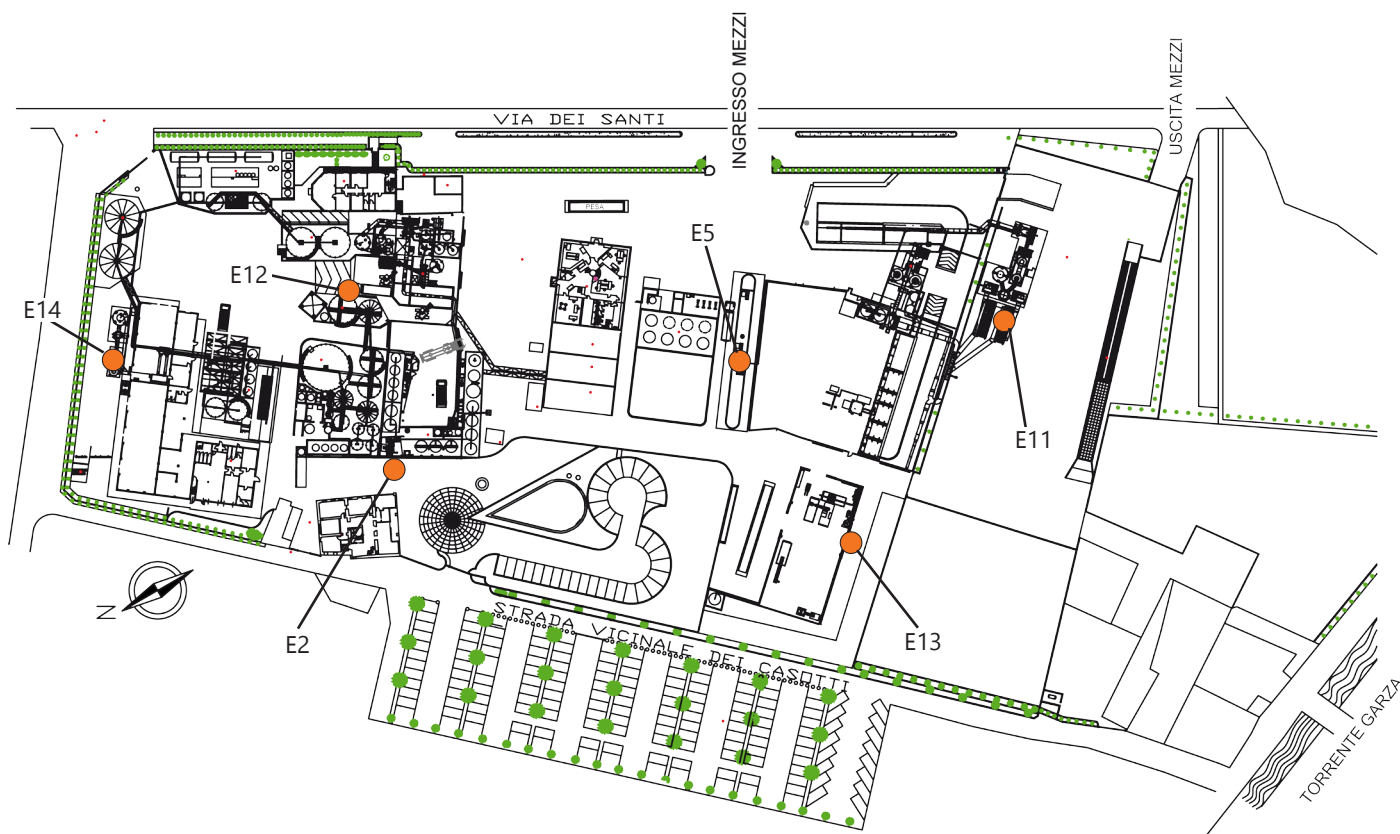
Planimetria dell'U.O. di Brescia con indicazione dei punti di emissione ●
